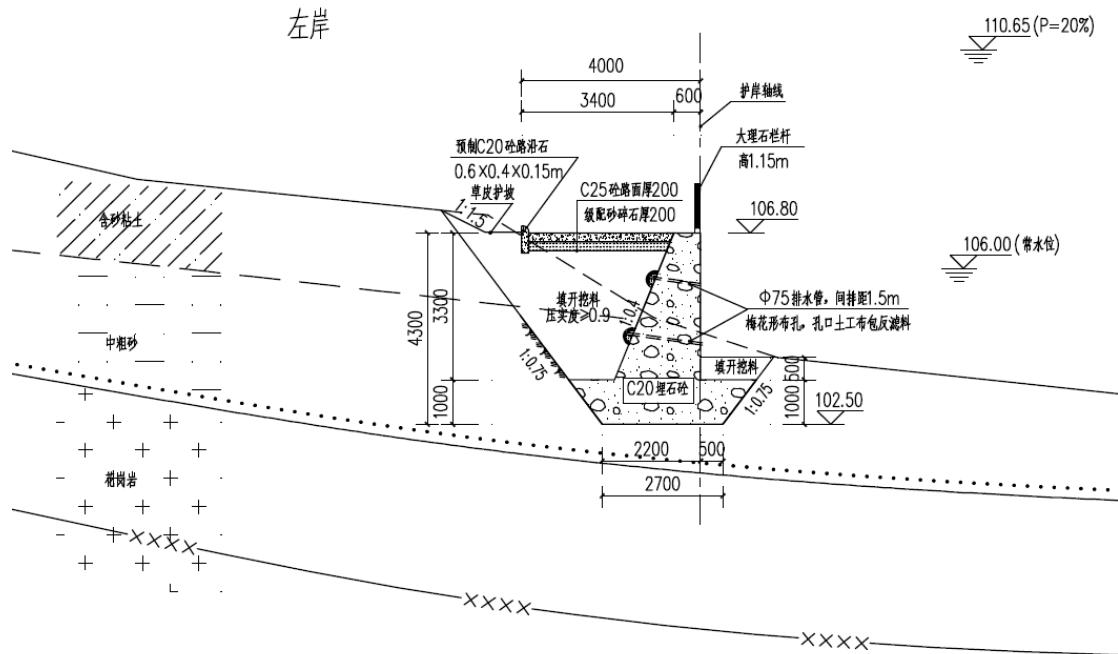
混凝土结构+生态砖护坡护岸典型剖面图
